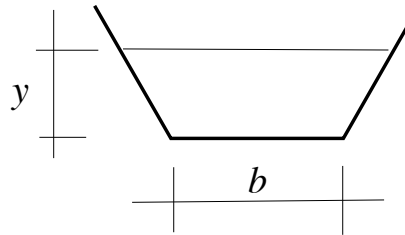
Sezione trapezia con sponde inclinate di 45° gradi.
